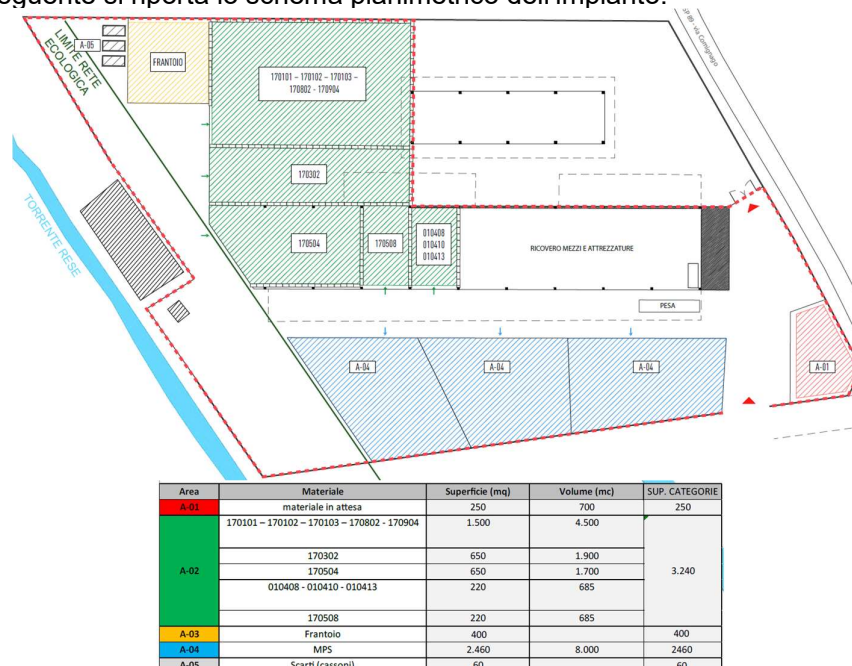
Planimetria dell'impianto (estratto tav.2 “Planimetria generale - suddivisione aree”)
